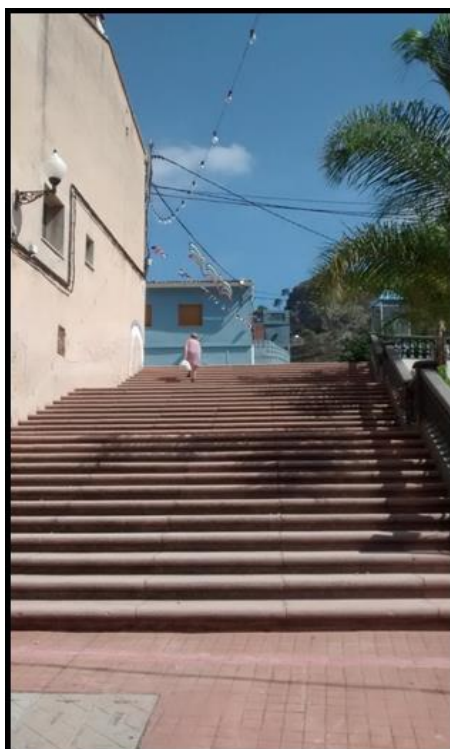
Escalera con ancho superior a 5 m carente de pasamanos central y lateral. El número de escalones seguidos es superior a 10. No existe pavimento señalizador en el embarque y desembarque de la escalera. Fuente: imagen propia.
